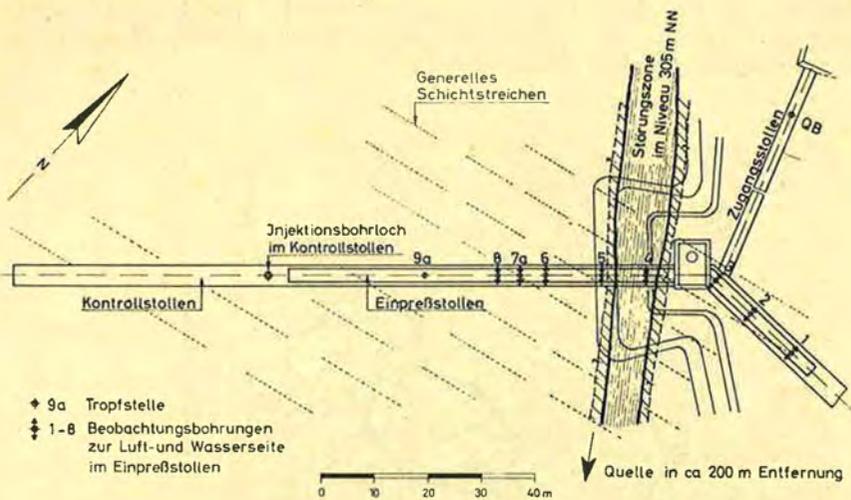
Biggetalsperre; Lageplan des Stollensystems mit Wasserbeobachtungsstellen.
